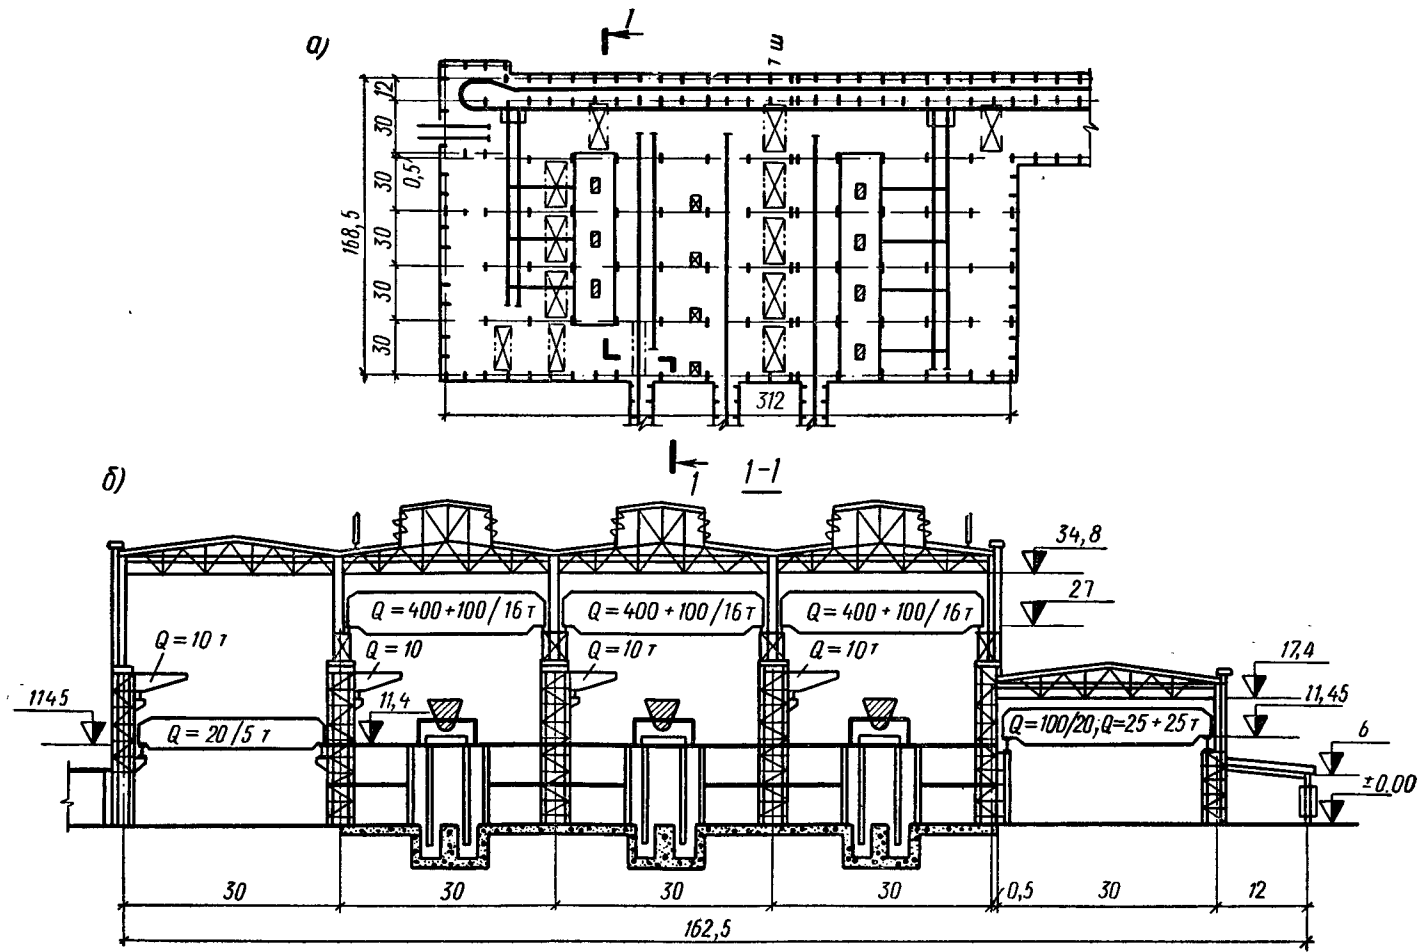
Здание цеха для установок непрерывной разливки стали:
